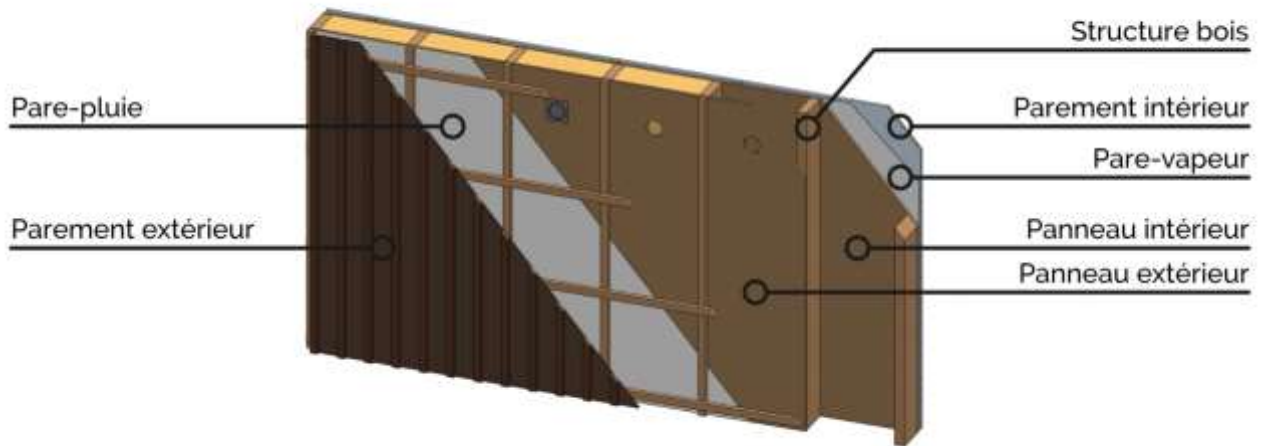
Insufflation depuis l'extérieur d'une cavité de Mur à Ossature Bois ou Façade à ossature bois
